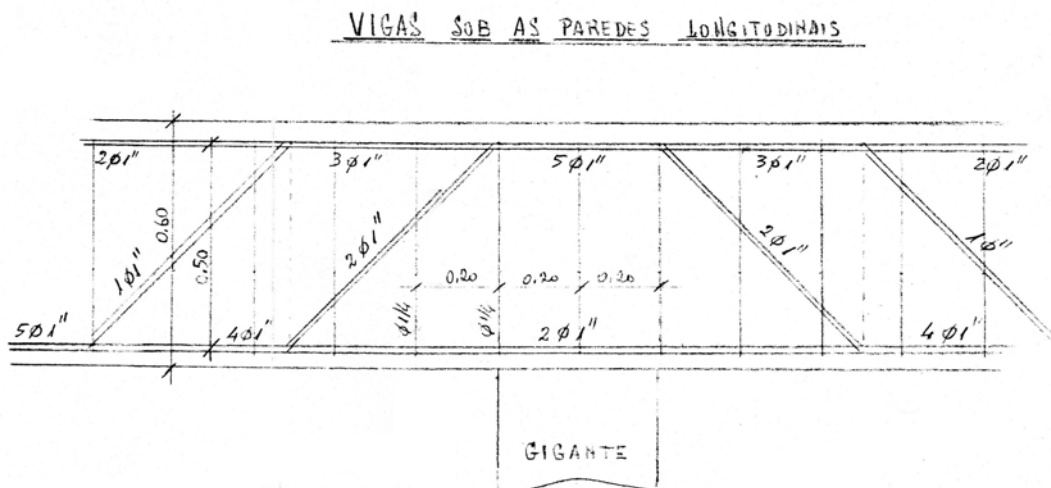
Viaduto das Fragas Más – estrutura de betão armado – vigas sob as paredes longitudinais (fonte: REFER)
